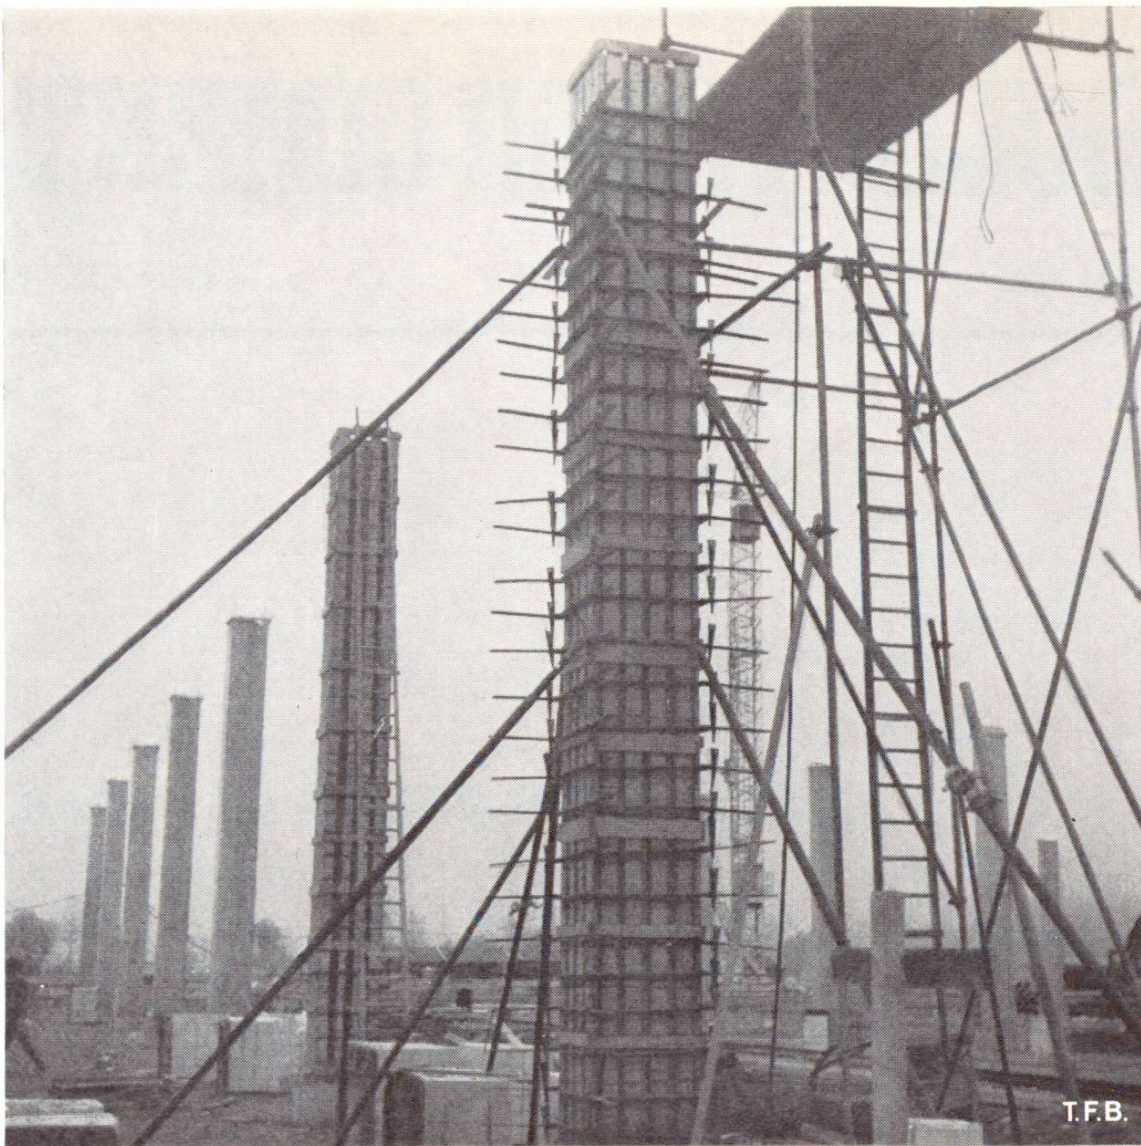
Coffrage pour piliers de 6 m, prêt au bétonnage. Pression du béton à la base: 10 à 15 t/m<sup>2</sup>.
